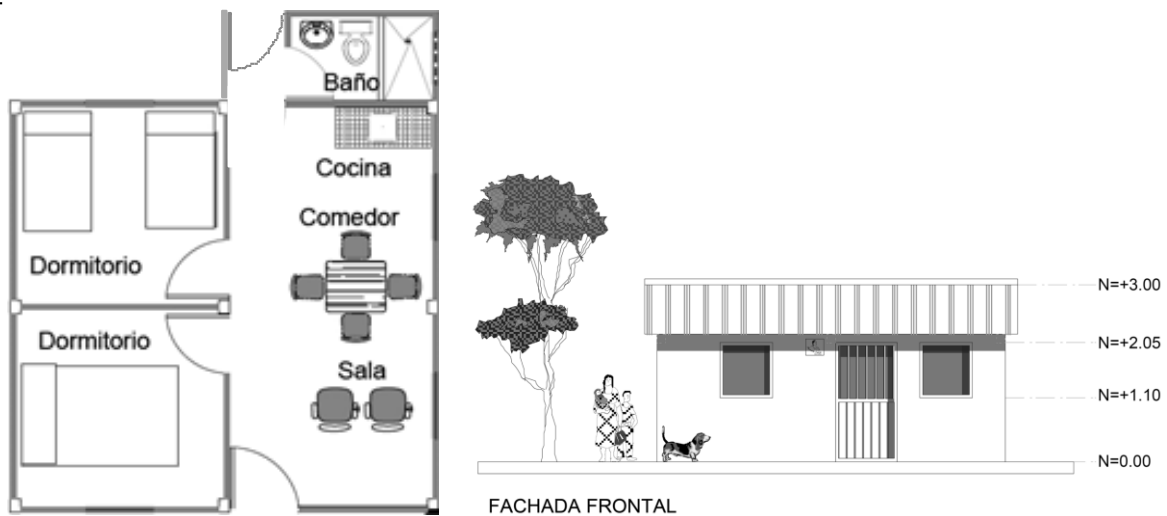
Planta arquitectónica y fachada frontal, sin escala, de la vivienda del MIDUVI. Fuente: www.habitatyvivienda.gob.ec.
